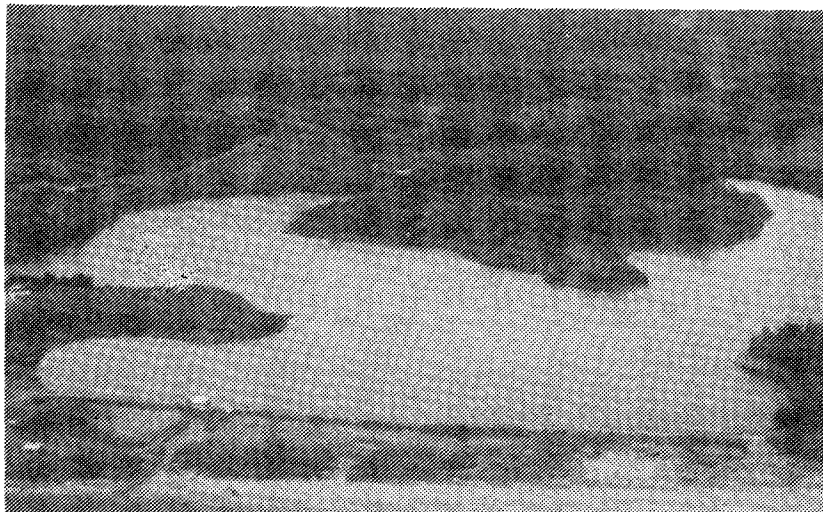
Construcción de piscinas camaroneras en tierras altas. Esmeraldas. 1987.
